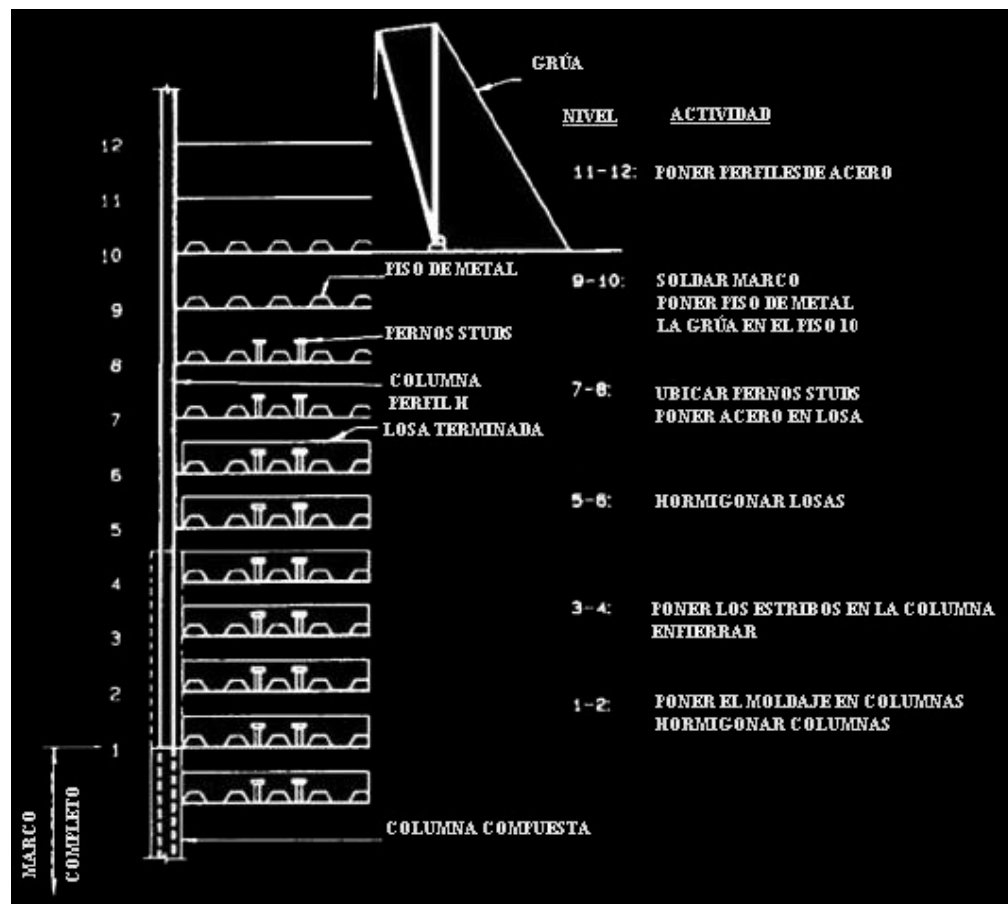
Secuencia de construcción de una columna SRC con un marco compuesto [3]
